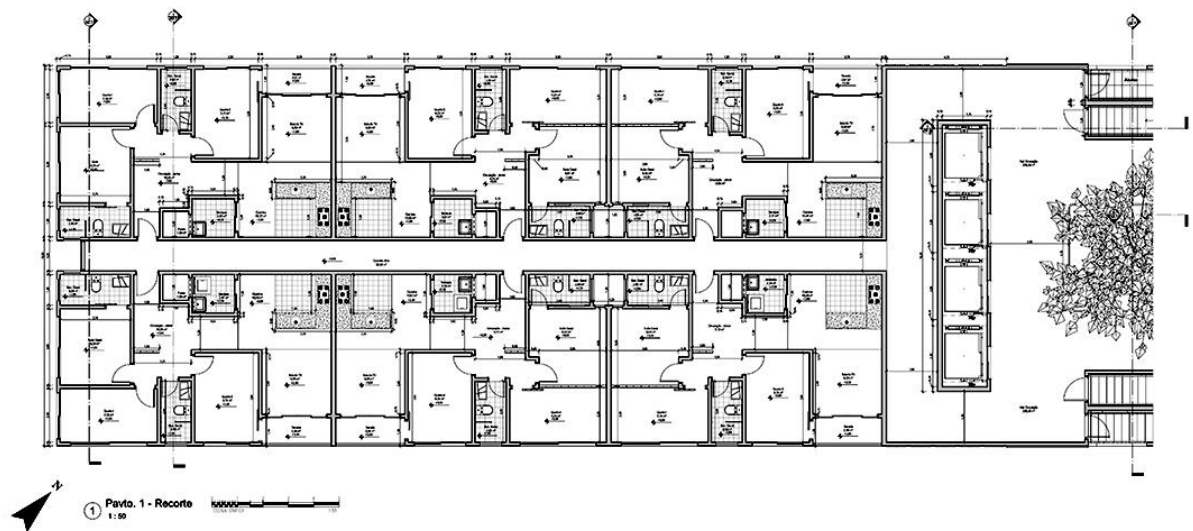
Planta Baixa – Recorte – Projeto Sanctum.
